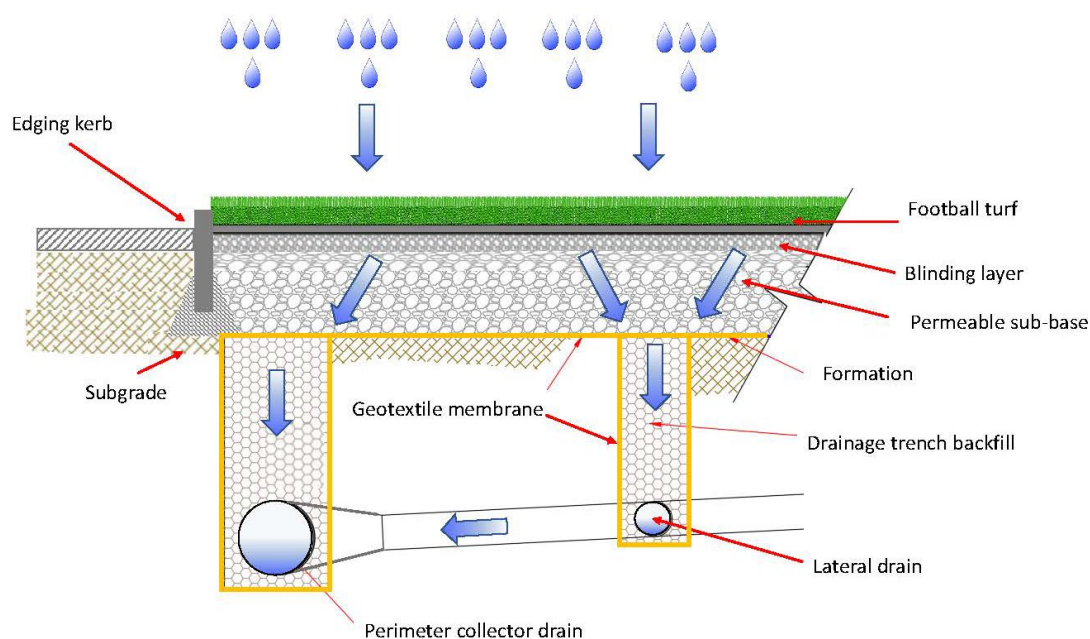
Ilustração da construção de campo com drenagem subterrânea vertical
